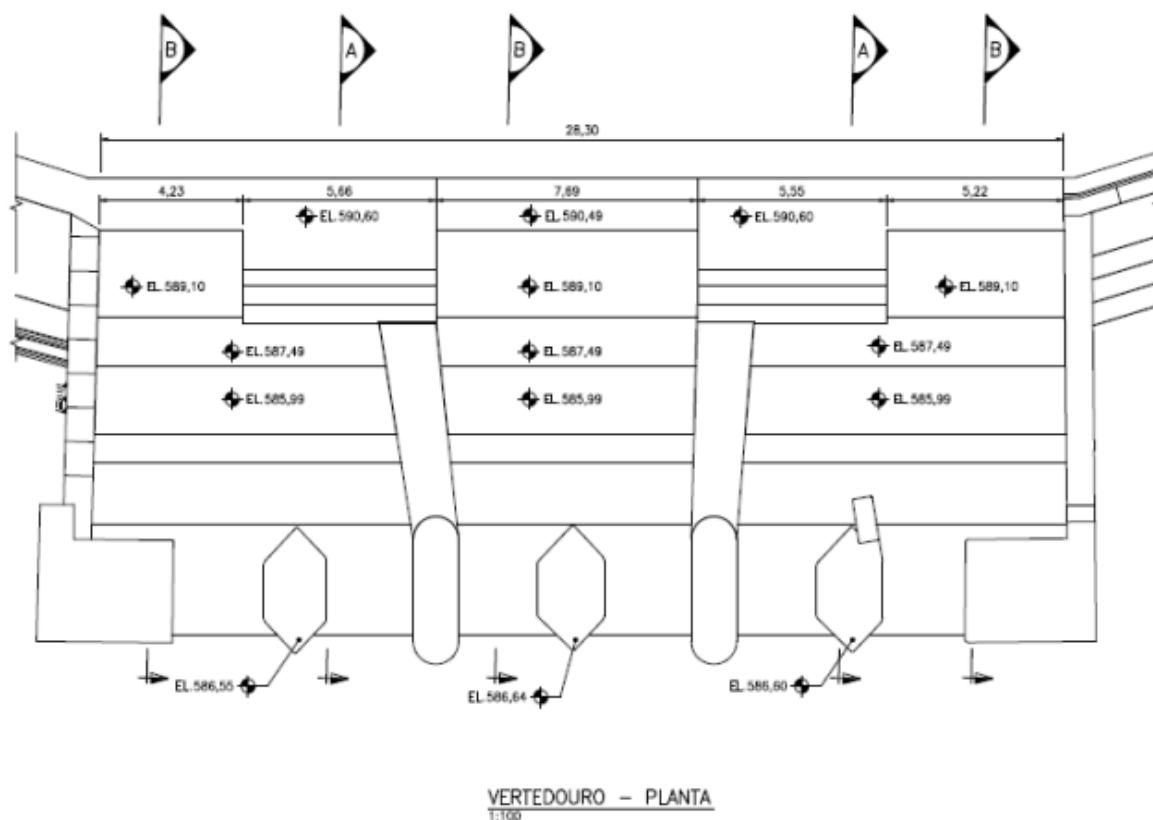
Planta do Vertedouro de Superfície da CGH Votorantim.
